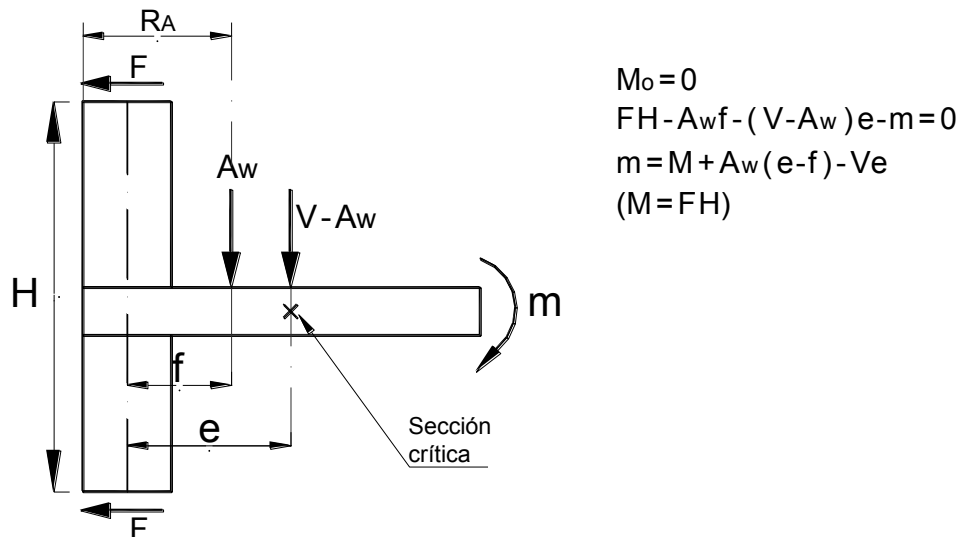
Equilibrio entre la sección crítica de la losa y los puntos de inflexión de las columnas.
